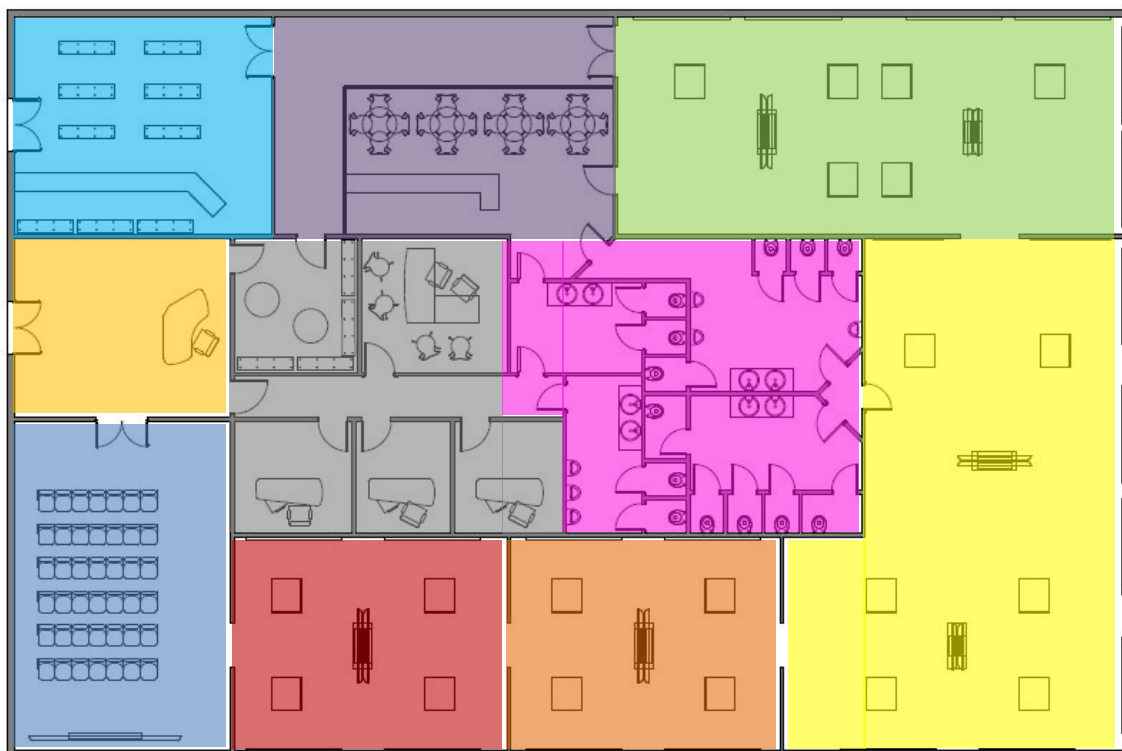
Plano del centro de interpretación.¹⁵⁹
